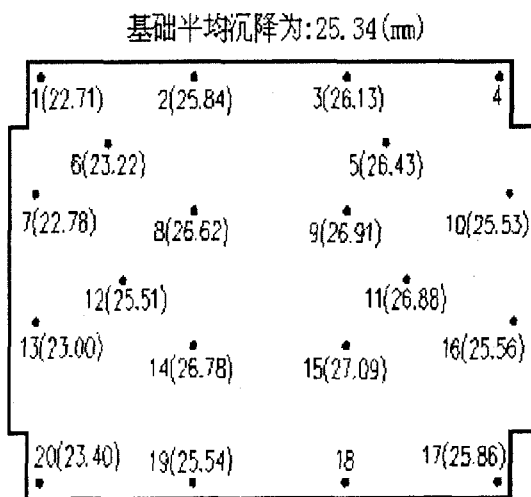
观测点的平面布置和沉降观测结果图(单位:mm)
